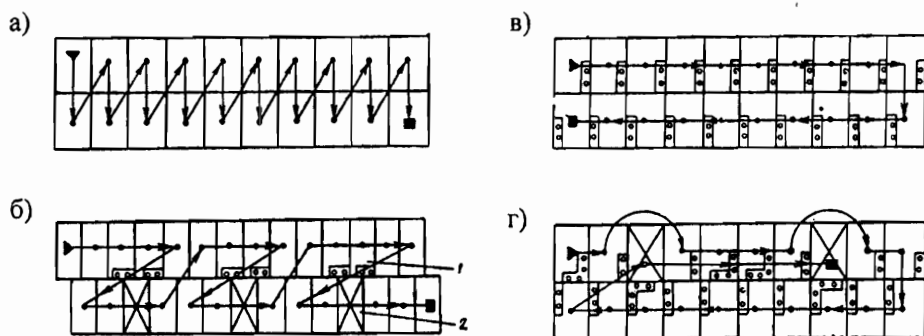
Последовательность монтажа зданий из объемных блоков: а – без наружных коммуникаций; б – с наружными коммуникациями на торцевой грани; в – с наружными коммуникациями на продольной грани; г – с наружными коммуникациями на торцевой и продольной гранях; 1 – блоки с наружными стыкующимися во время монтажа санитарно-техническими коммуникациями; 2 – блоки лестничной клетки (стрелками показана технологическая последовательность монтажа объемных блоков)
